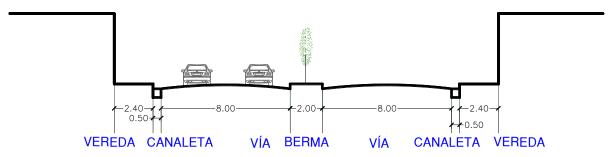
Propuesta de vía colectora- Joaquín Capelo Fuente: Plan de desarrollo urbano.
